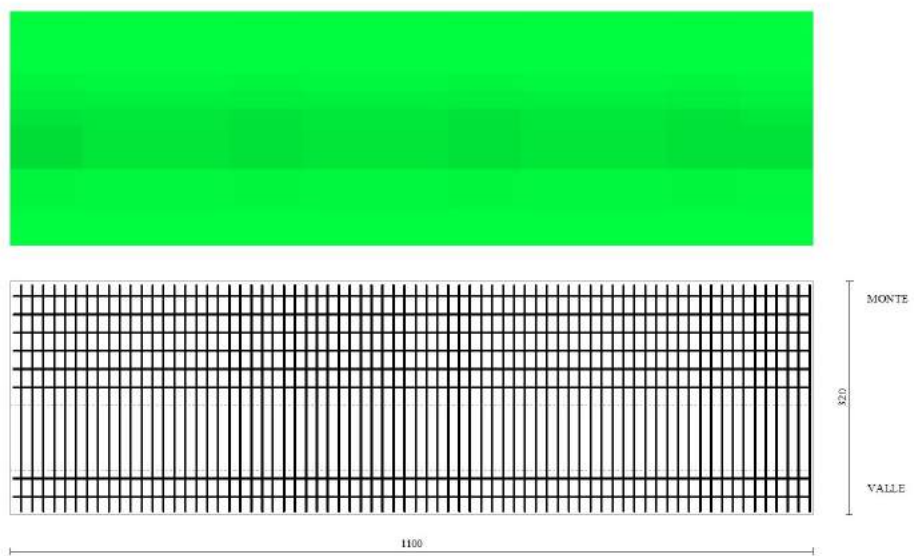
Piastra fondazione dir. Y (Inviluppo)
